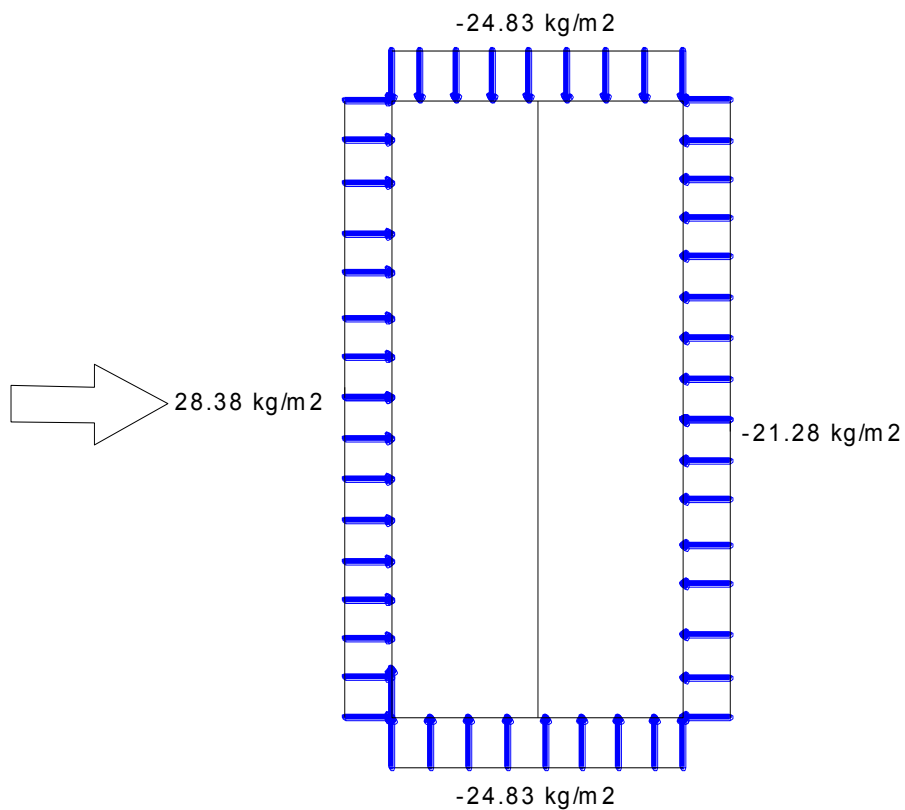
Primer caso W_x : viento paralelo los pórticos (techo inclinado menor a 15°) planta. Fuente elaboración propia.
